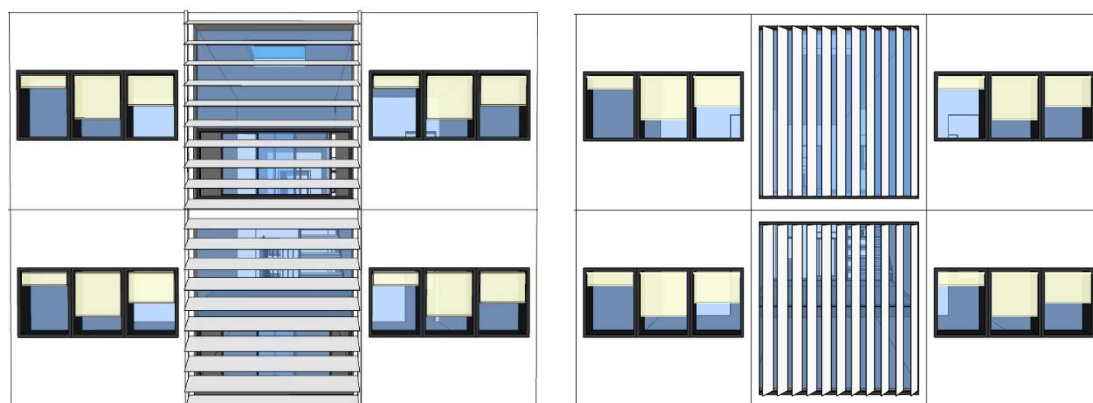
Vue en perspective - Scénario d'installation des brise-soleils sur les fenêtres toute hauteur
